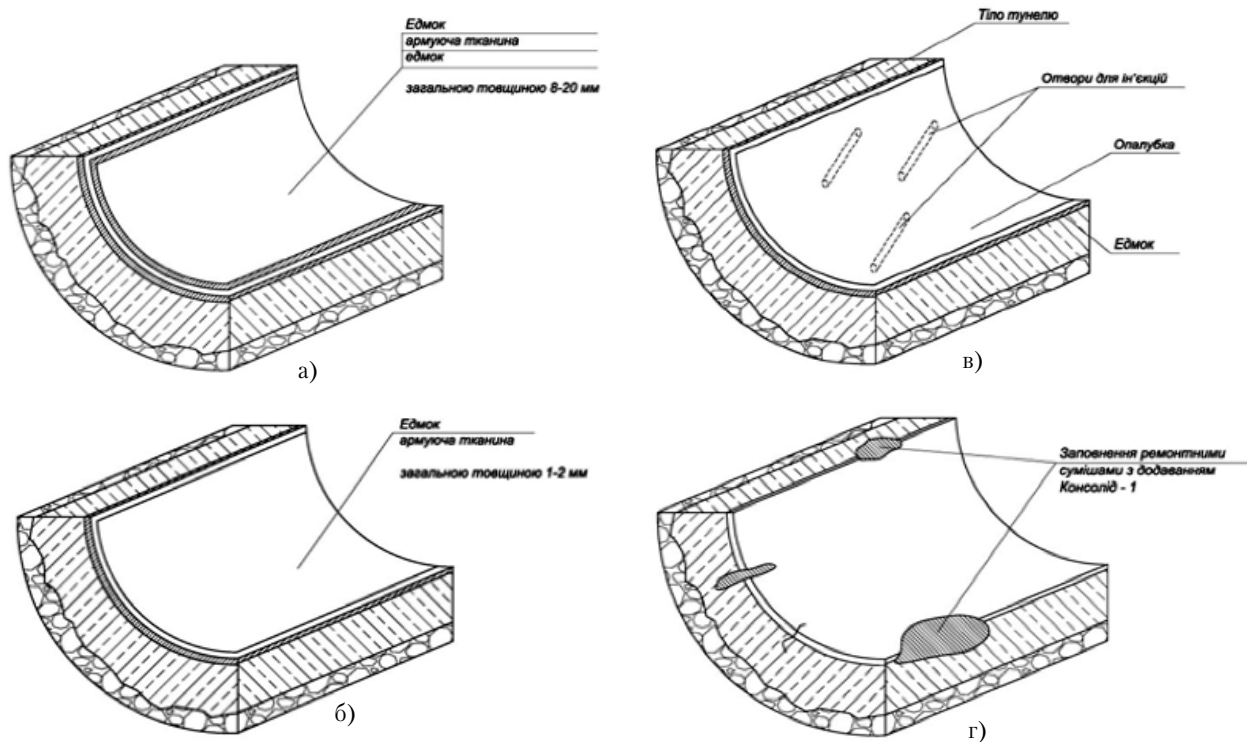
Схема виконання робіт із ремонту внутрішньої поверхні тунелю: а – з утворенням суцільного захисного покриття з армуванням спеціальними тканинами товщиною 8-20мм, б – з утворенням суцільного захисного покриття з армуванням спеціальними тканинами товщиною 1-2мм, в – з утворенням суцільного захисного покриття ін'єктуванням композитного матеріалу в простір утворений опалубкою та стінкою тунелю, г – додавання полімерної композиції до ремонтних сумішей
